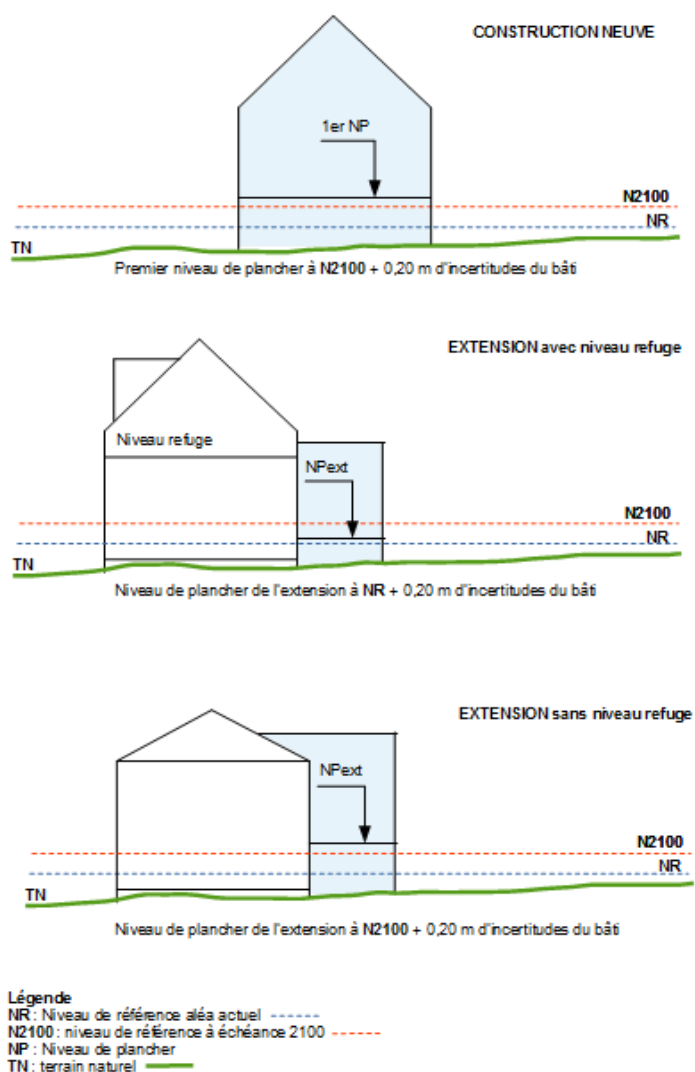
Exemple de définition de la cote du niveau plancher du projet à partir de la cote d'eau
